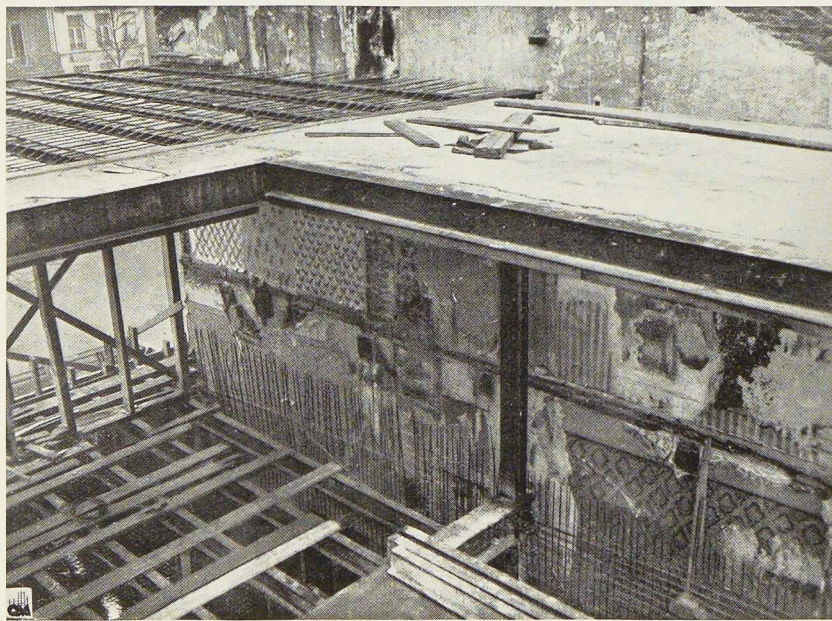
Coulage du hourdis constitué par une dalle en béton armé enrobant les solives métalliques.
